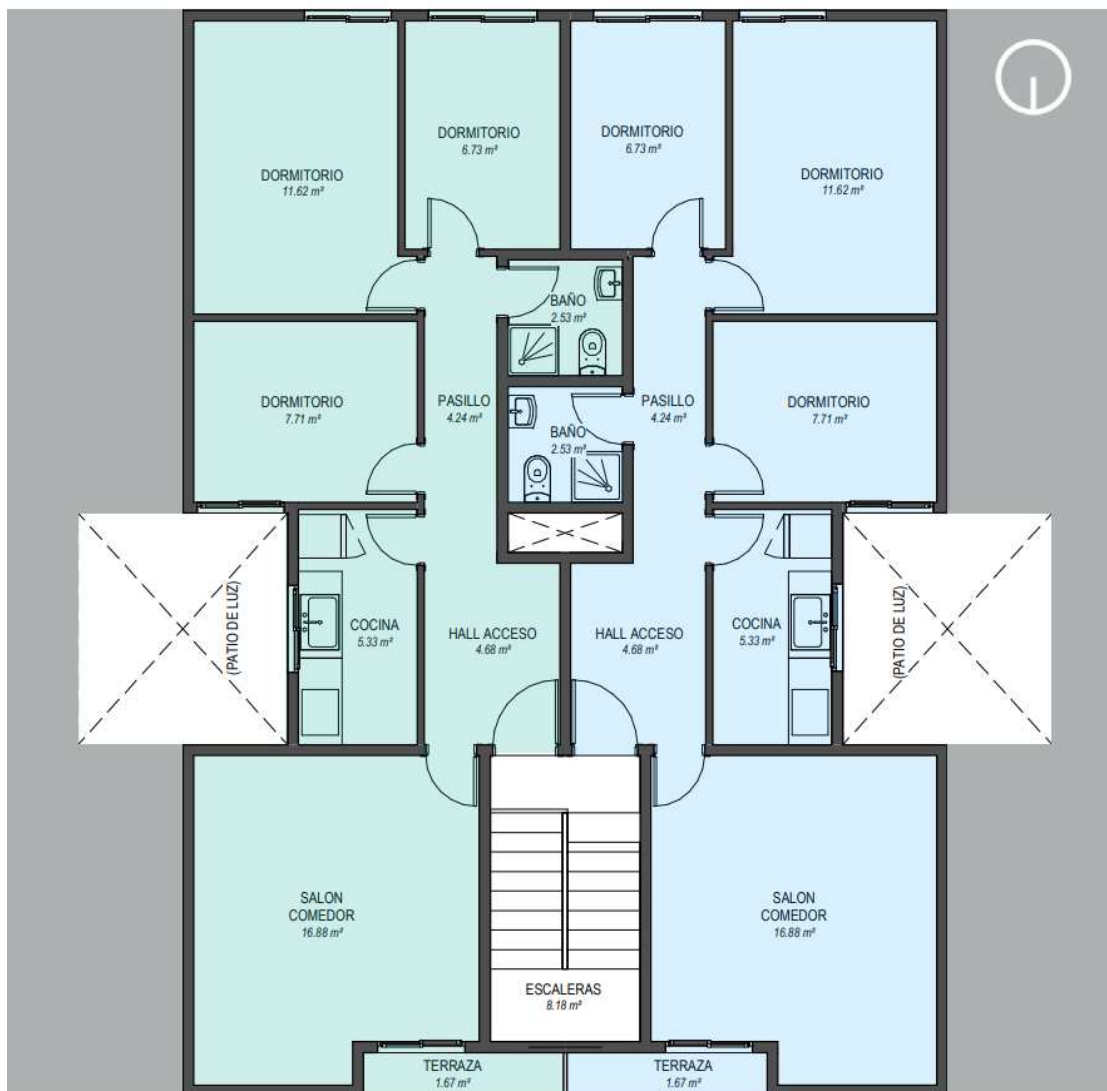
Planta general de distribución del edificio. Elaboración propia.
